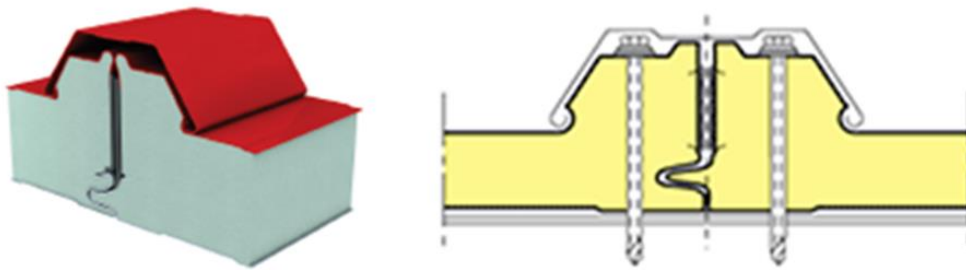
Ilustración del encaje machihembrado y tapajuntas de los paneles
